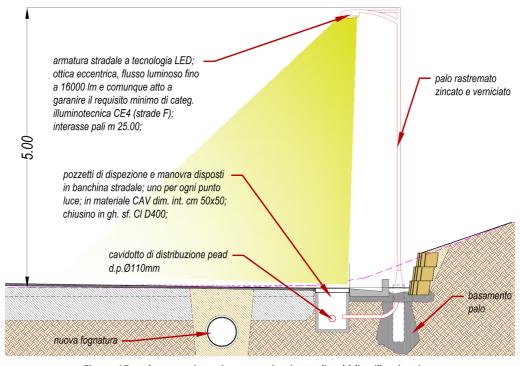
schema sezione tipo nuovo impianto di pubblica illuminazione
